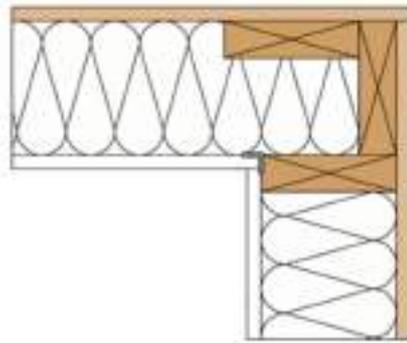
Elemento de canto do tipo *Hollow Corner*.
